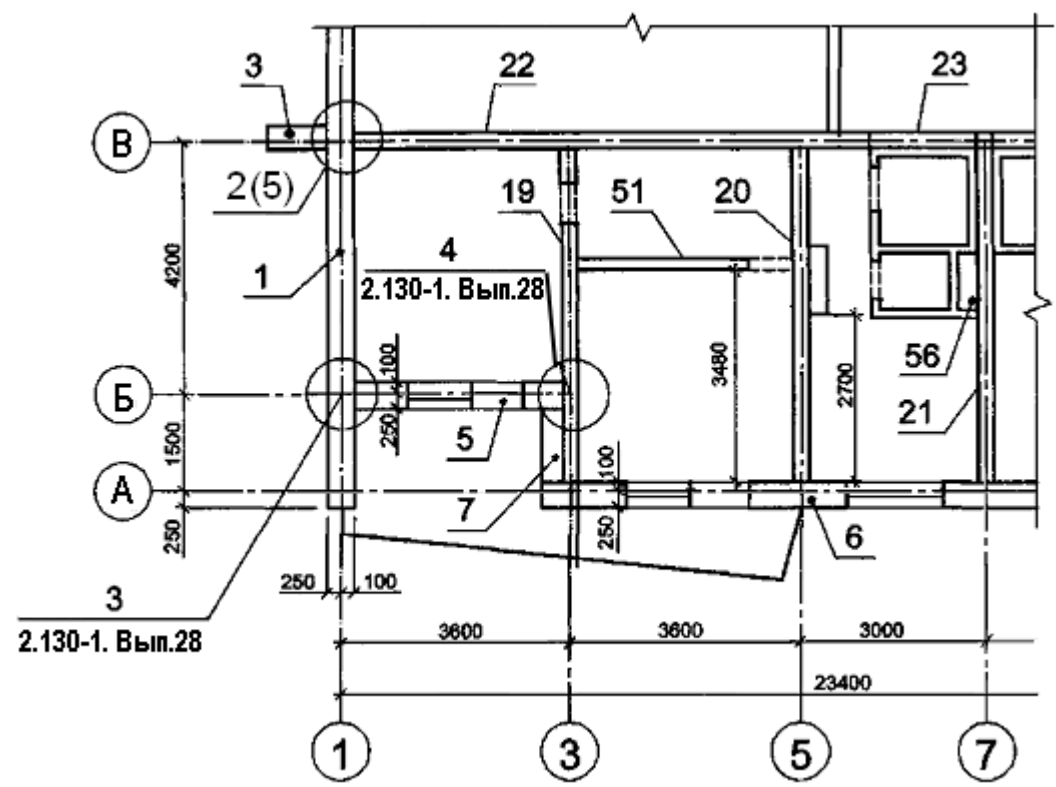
Схема расположения панелей стен, перегородок и других элементов жилого дома
